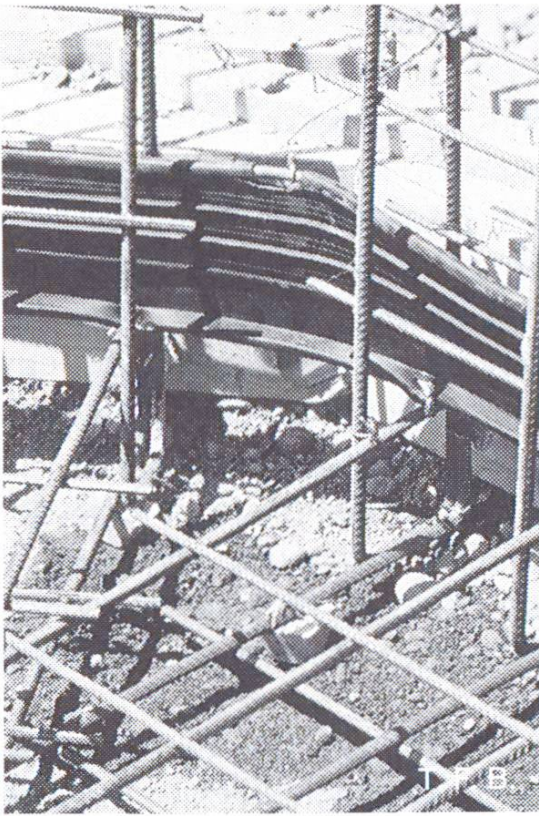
Après l'excavation, mise en place d'une couche de propreté en béton maigre afin que la dalle de fond puisse être coffrée et armée convenablement.
